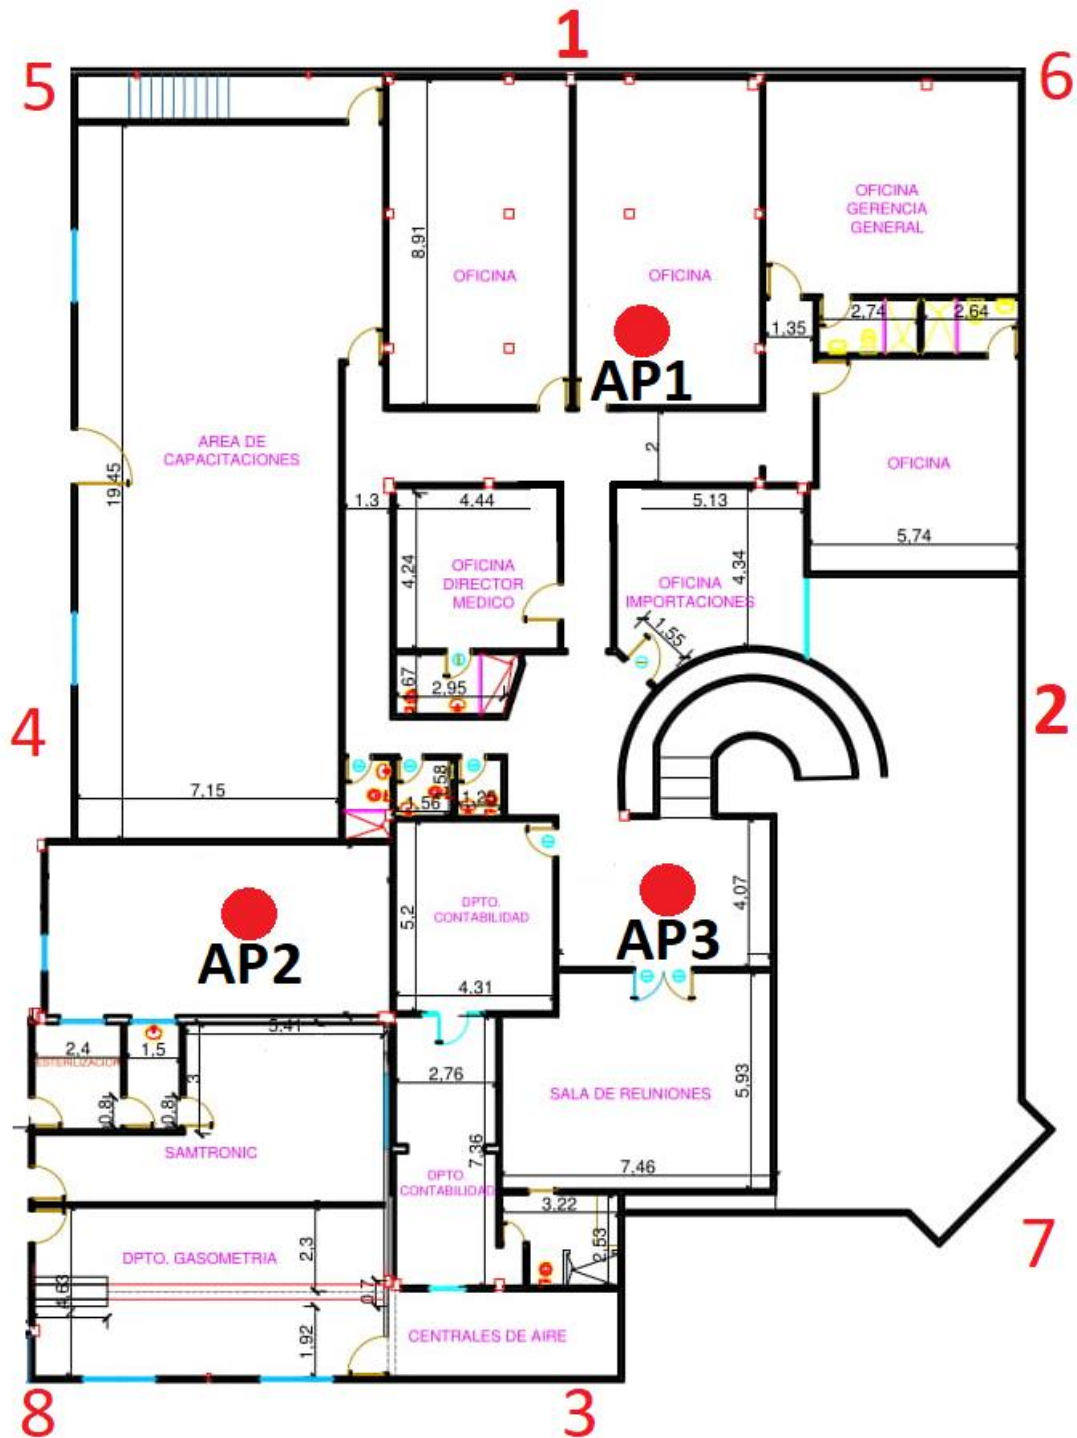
Ubicación de los AP en la planta alta, diseño final
